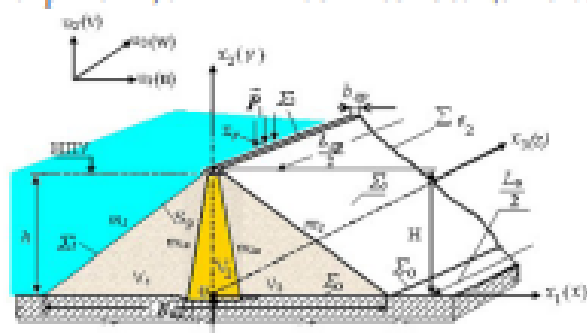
Модель грунтовой плотины с двояким водохранилищем.
